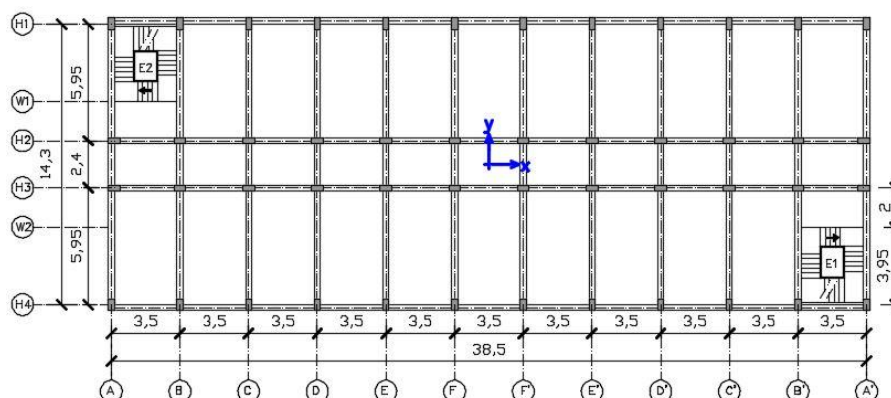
Planta estrutural tipo – desenho ilustrativo – dimensões em [m]
